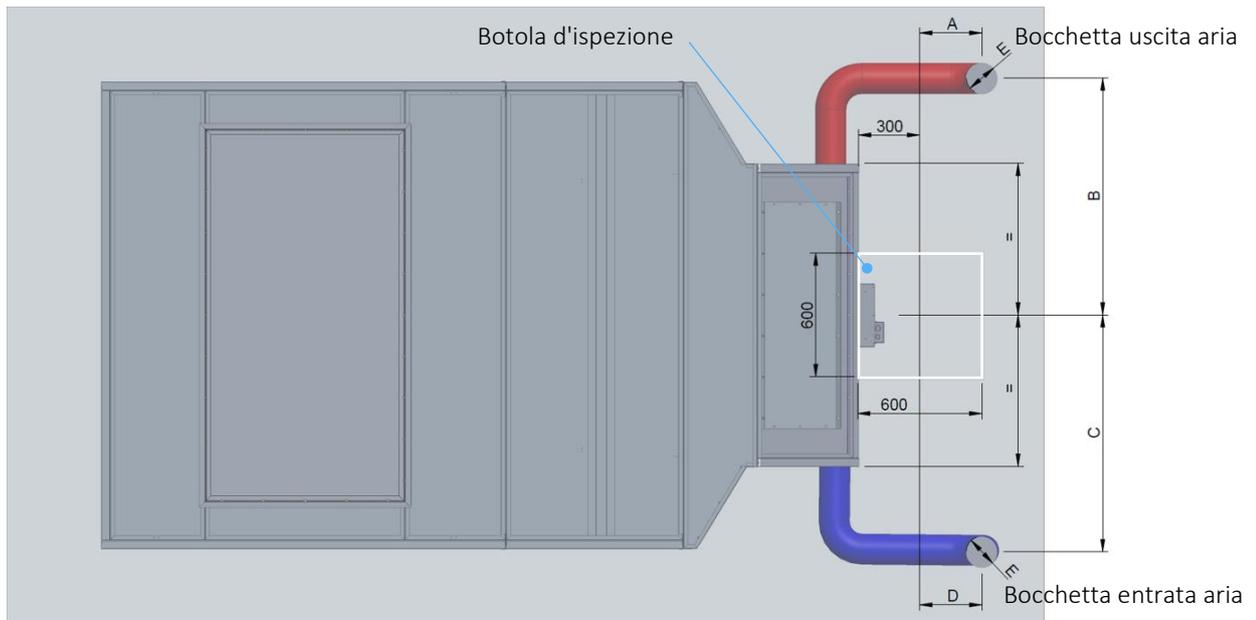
Disposizione della botola d'ispezione e del sistema di ventilazione: vista dal basso
